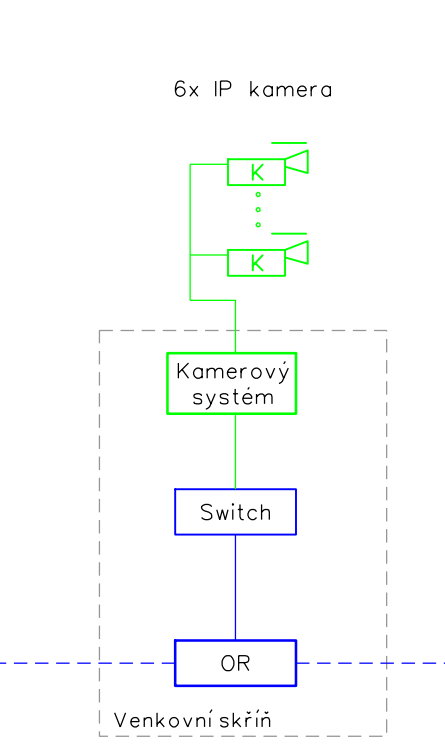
DETAIL B - KAMEROVÁ SKŘÍŇ KS-2
